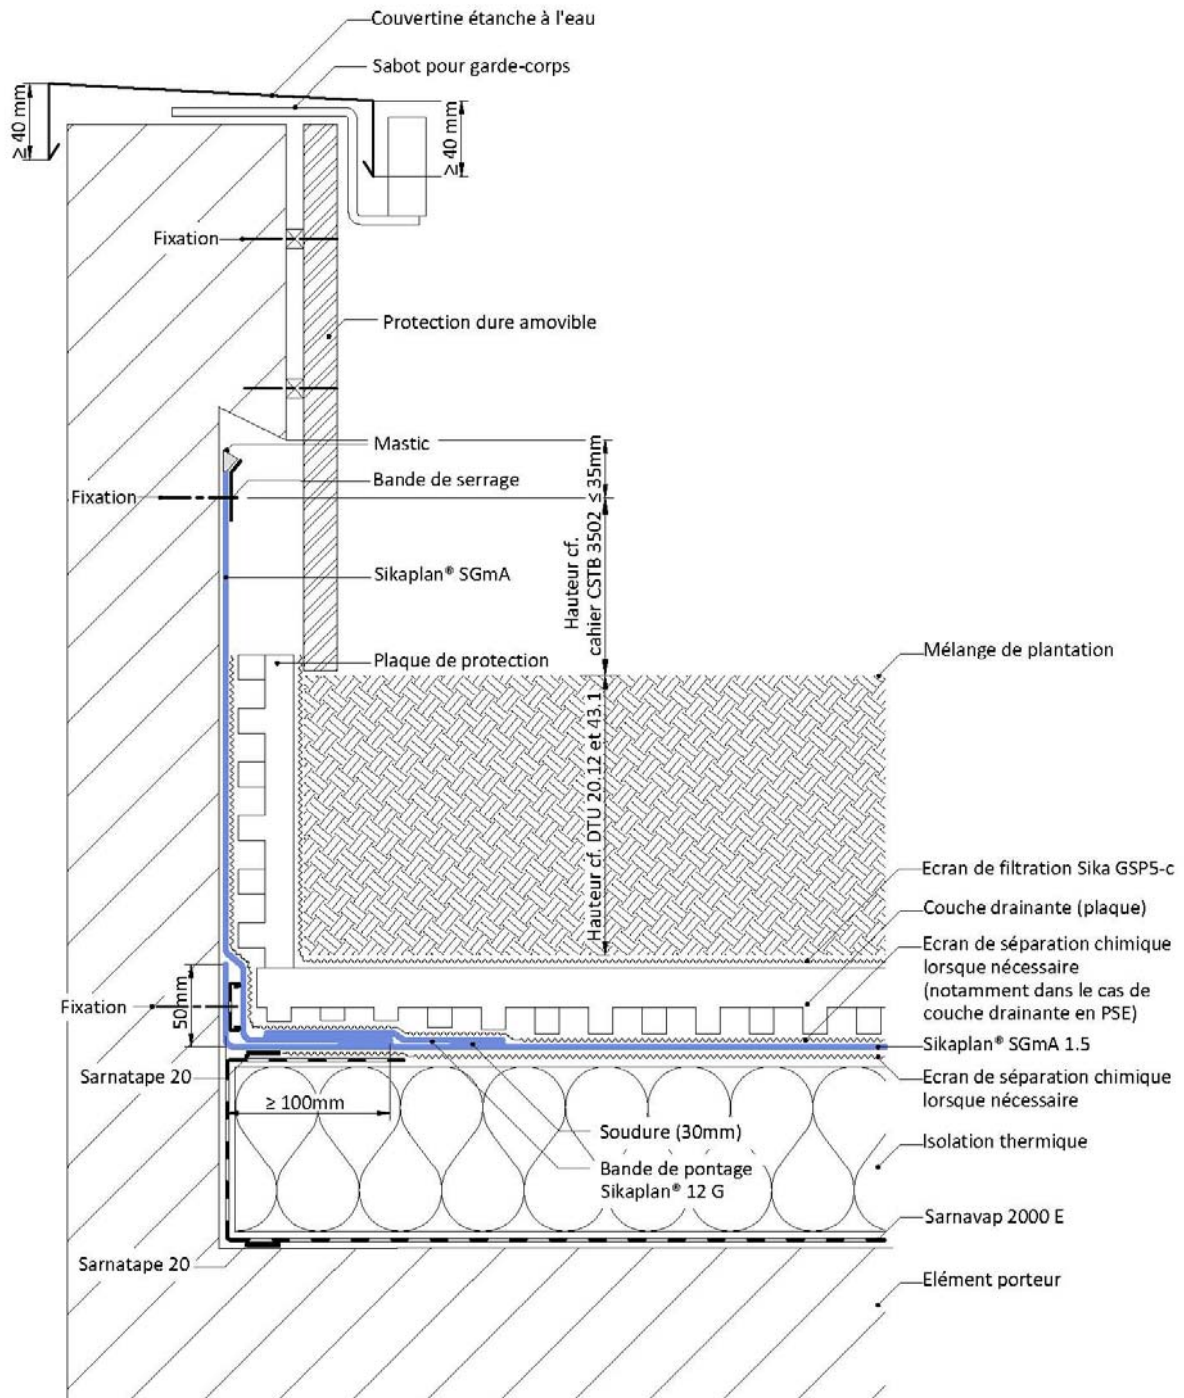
Relevé d'étanchéité sous couvertine et protection amovible sous DTA – Travaux neufs sur maçonnerie – Terrasse jardins – Surface < 100 m² - Elément porteur avec état de surface « lissé » au sens du DTU 21
